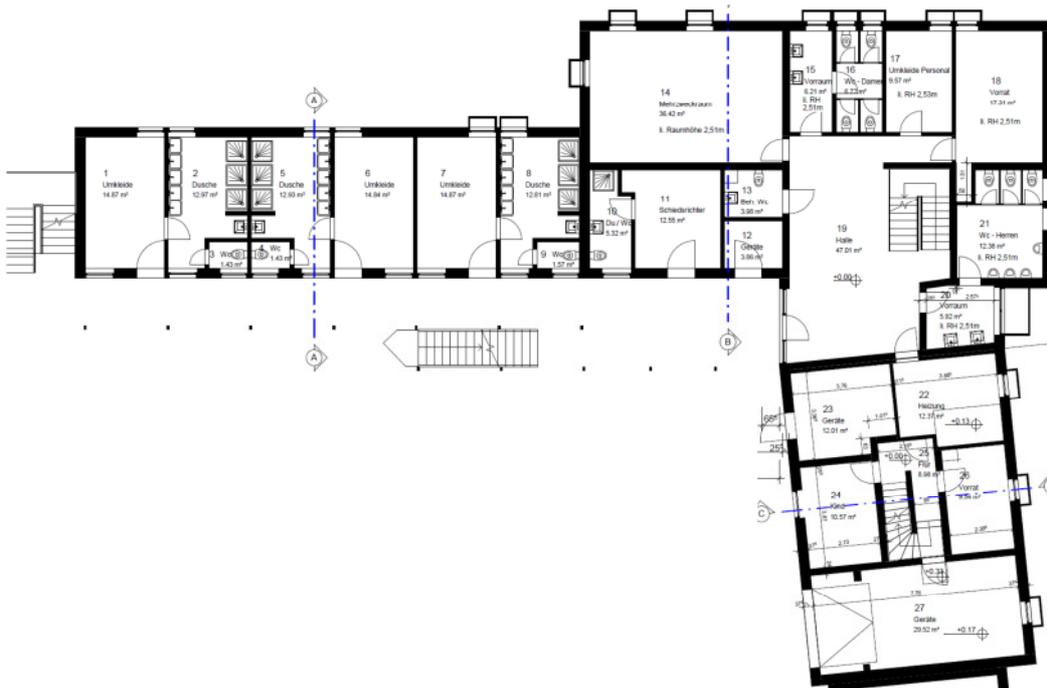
Grundriss Sportzentrum Untergeschoss (© Golinski Architektur)
